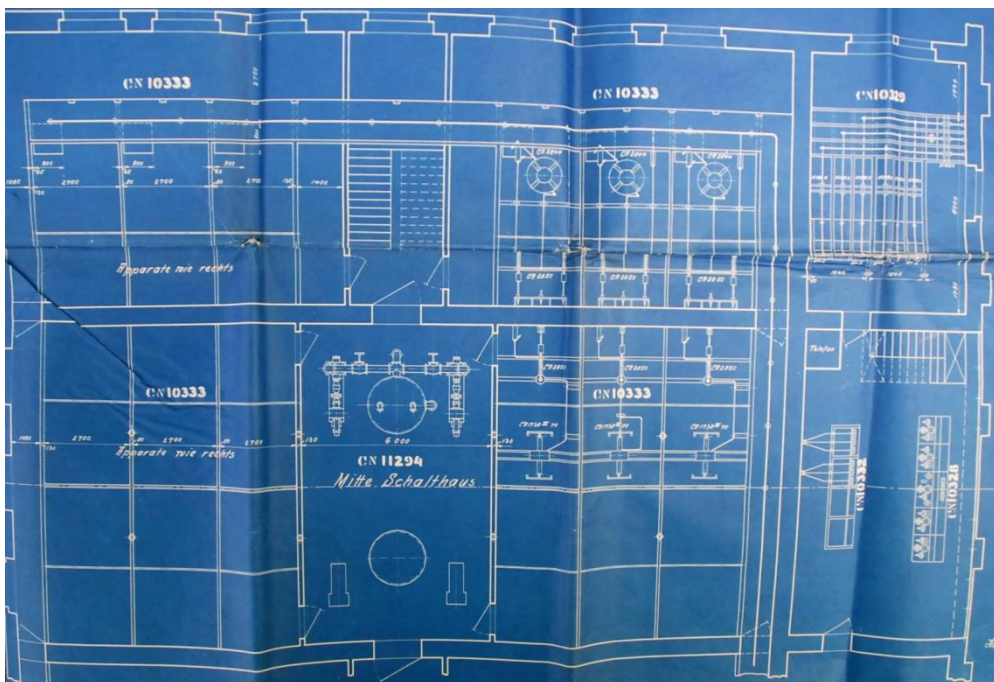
Planta de distribución de Planta Primera del Edificio de Transformadores. Proyecto.
